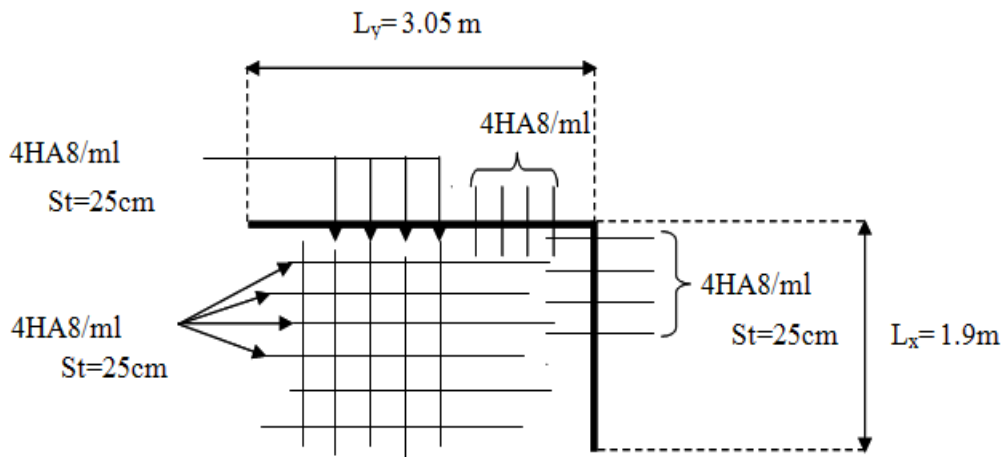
Schéma de ferrailage de la dalle sur deux appuis
